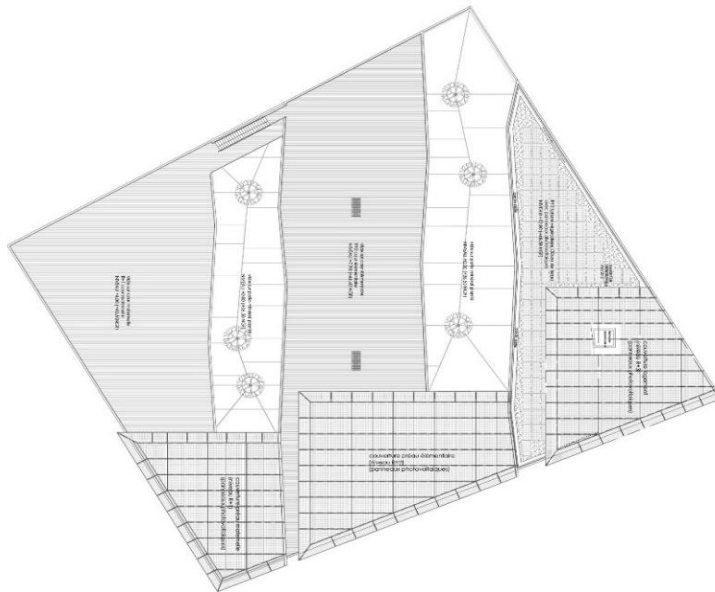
Planta Baixa do segundo pavimento da Zero Energy school.
